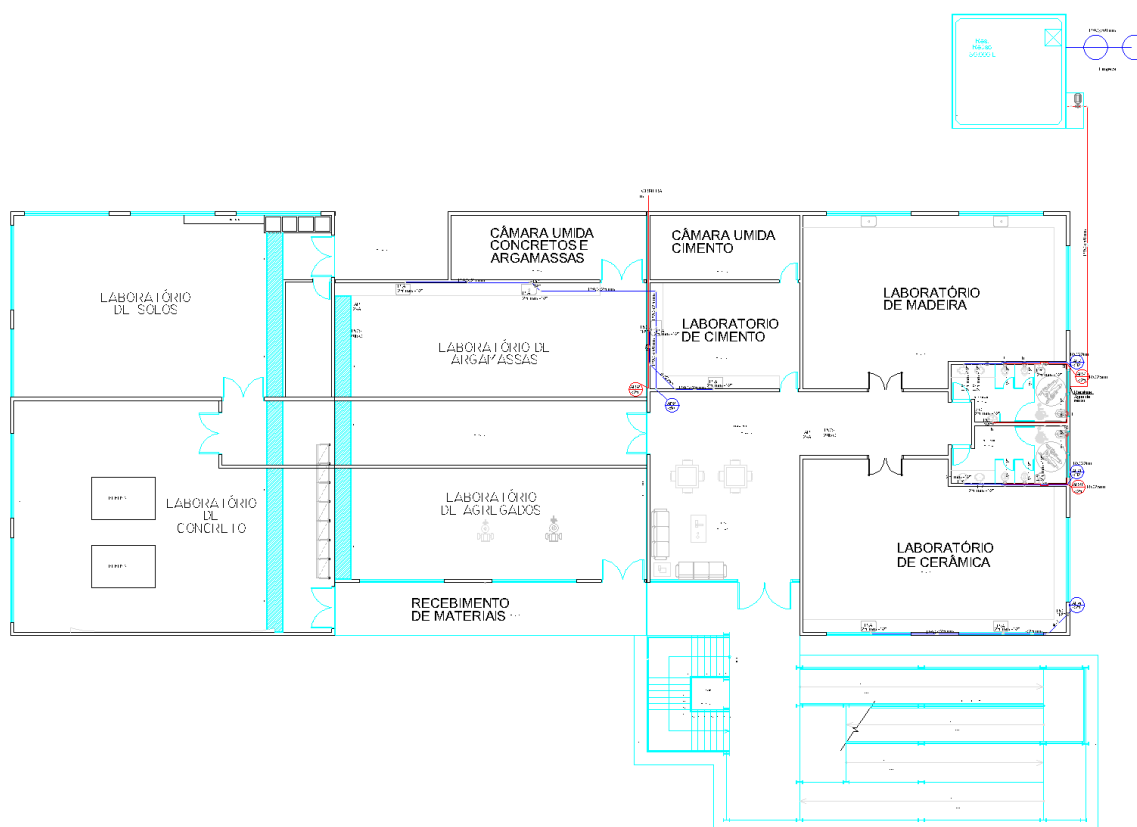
Projeto Hidráulico – Primeiro Pavimento – CTEC. Fonte: Autores (2022).
